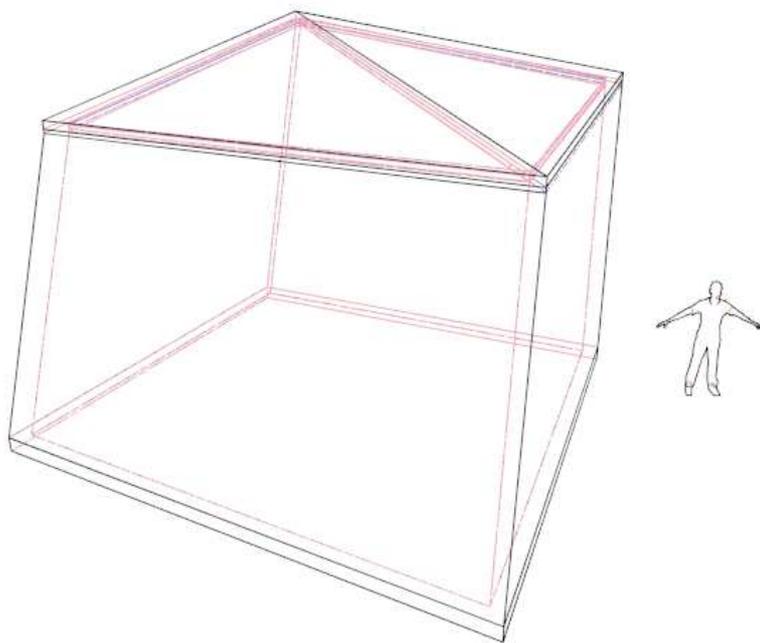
Levantamiento superficies 3D (Construction Line).
